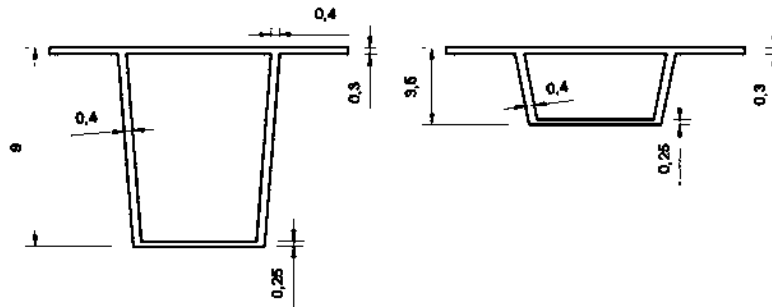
b Espesores de la sección transversal del puente voladizo balanceado (m).
